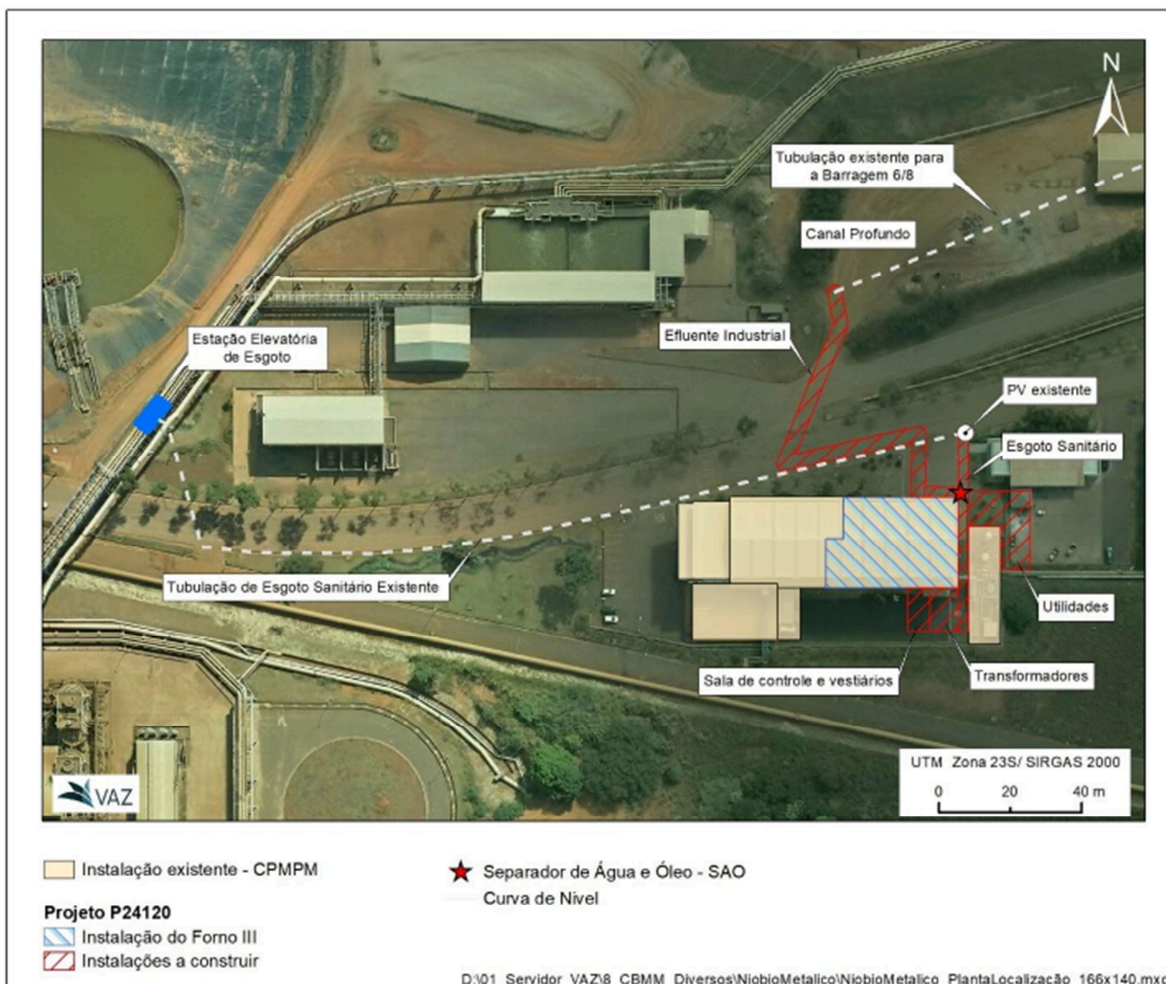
Planta de localização do projeto do novo forno e infraestruturas de apoio. Fonte RCA CBMM (2025).
